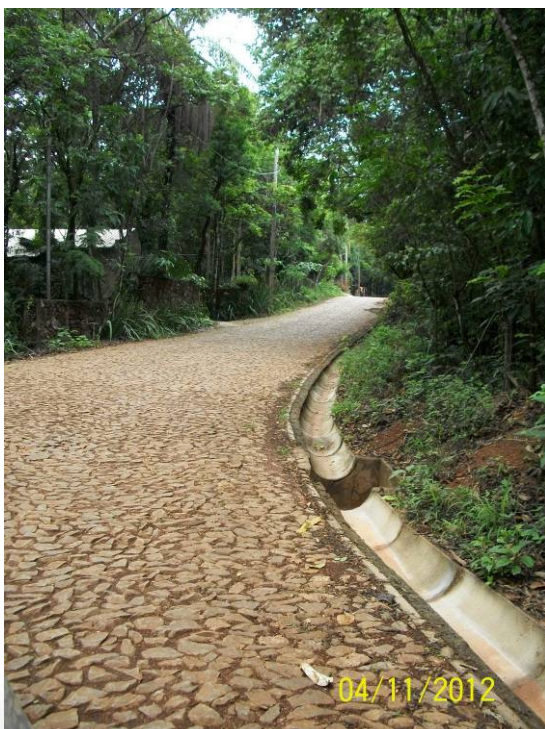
, 16, 17: Canaleta de concreto pré-moldado meia-cana e caixa de concreto de águas pluviais
